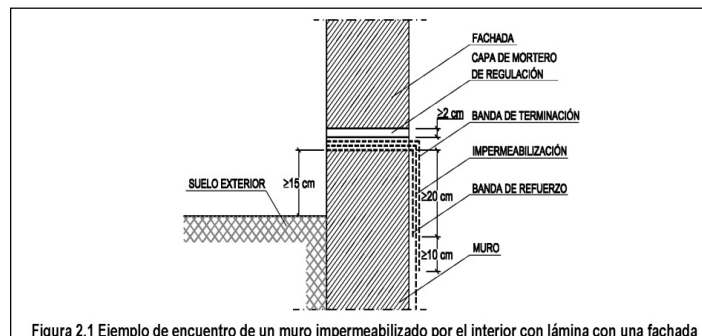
Ejemplo de encuentro de un muro impermeabilizado por el interior con lámina con una fachada
